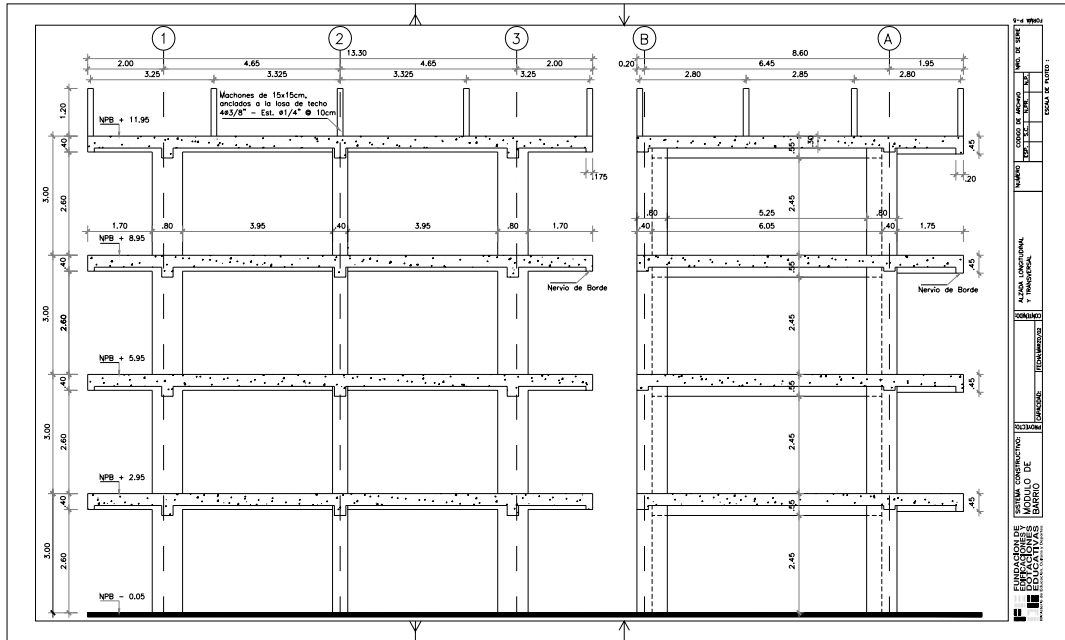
Alzada longitudinal y transversal. Modulo de Barrio.
